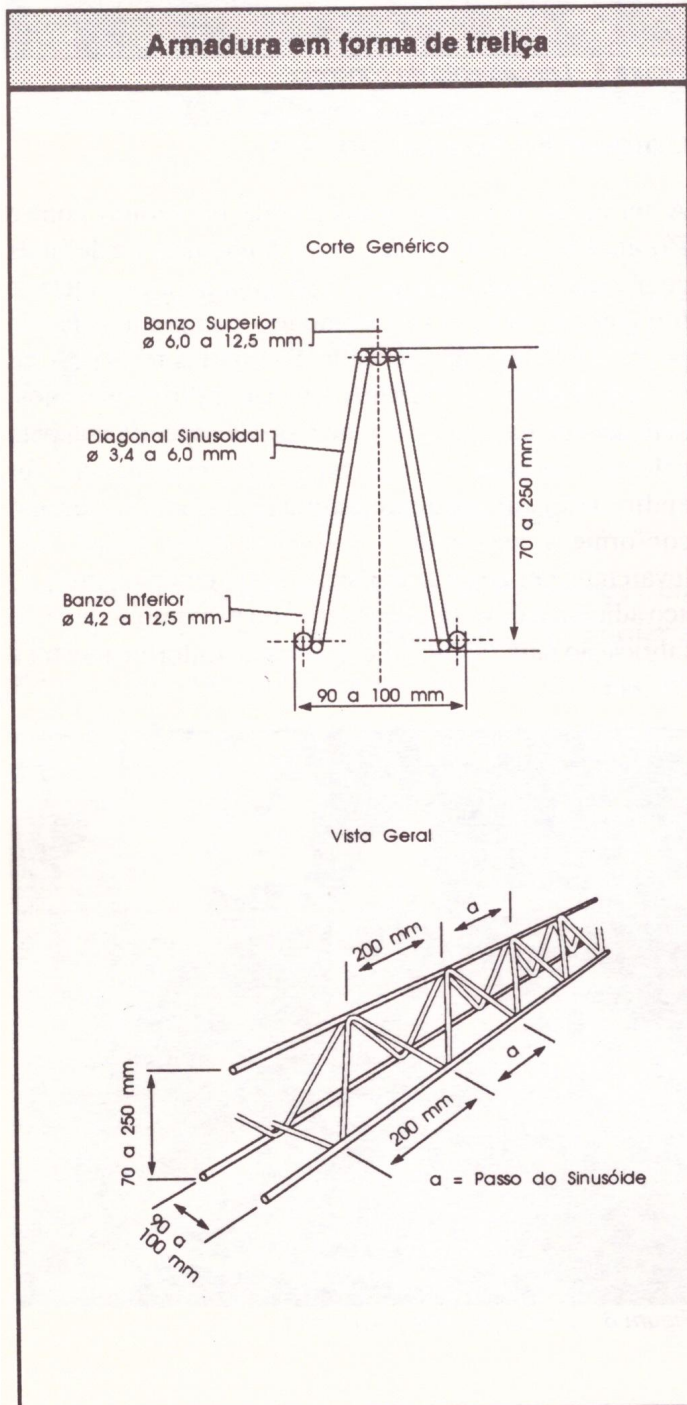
Corte transversal genérico da armadura treliçada e vista geral da armadura treliçada
